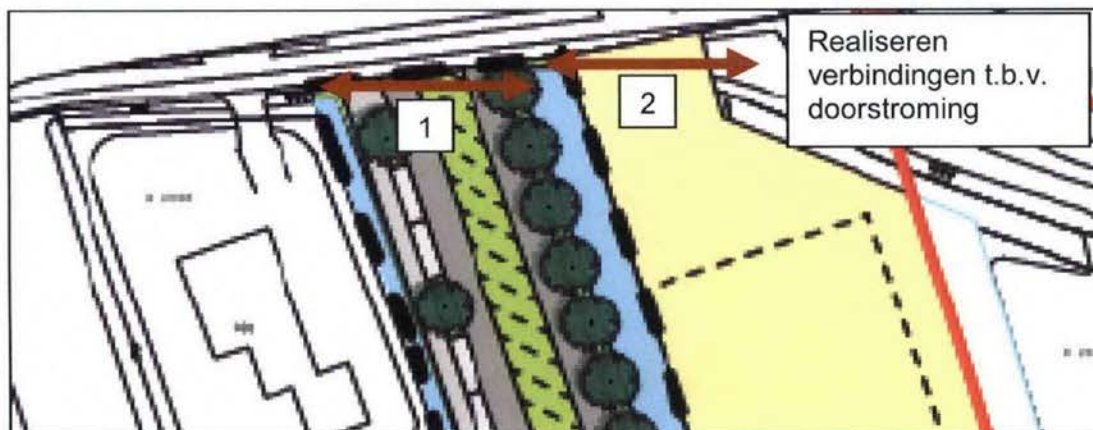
Groenstrook aan de achterzijde van de woningen vervangen door water.
